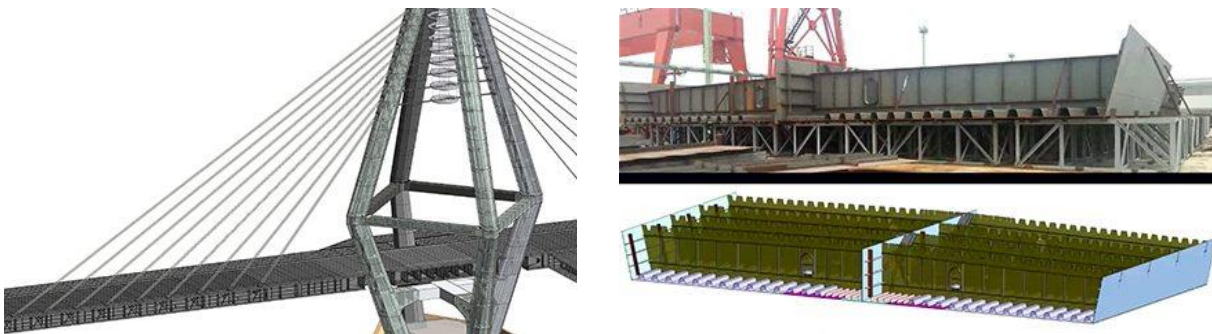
Estructuras Fanli Bridge (Fuente: Autodesk)
